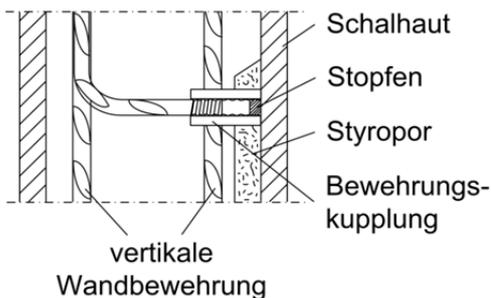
Deckenanschluss mit Schraubenmuffenstoss: Bauzustand - Schachtherstellung
